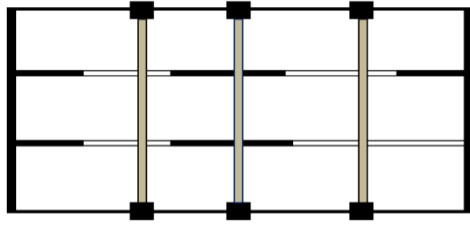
Ossature mixte refend intérieurs avec poteaux en façade
